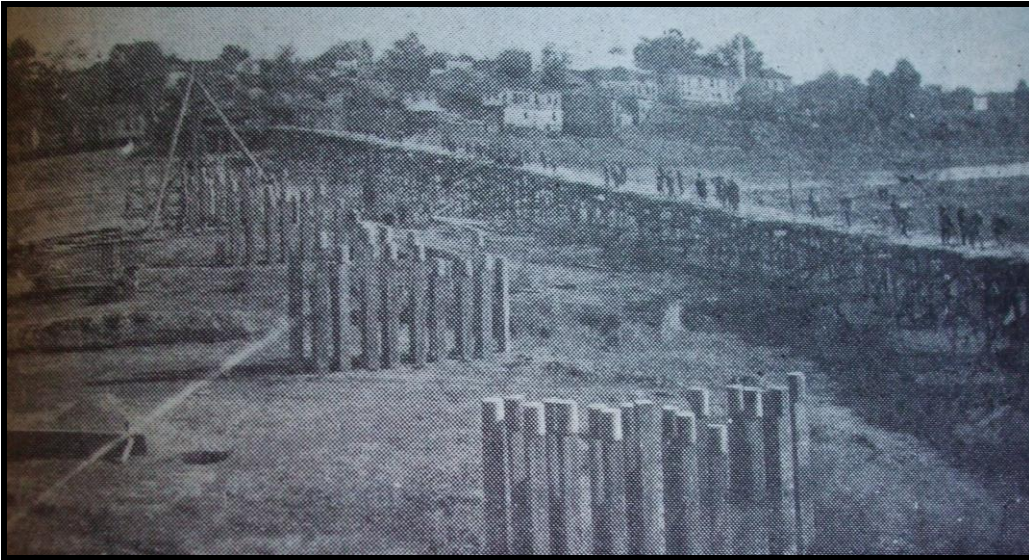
Betonarme köprünün temel kazıkları ile ahşap köprü yan yana (Anonim).
